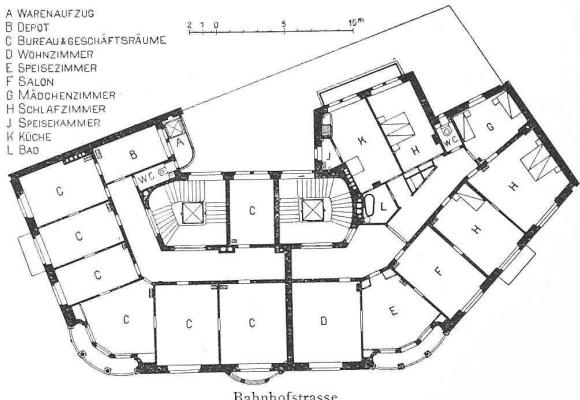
Grundriss vom dritten Obergeschoss. — Masstab 1:500.
